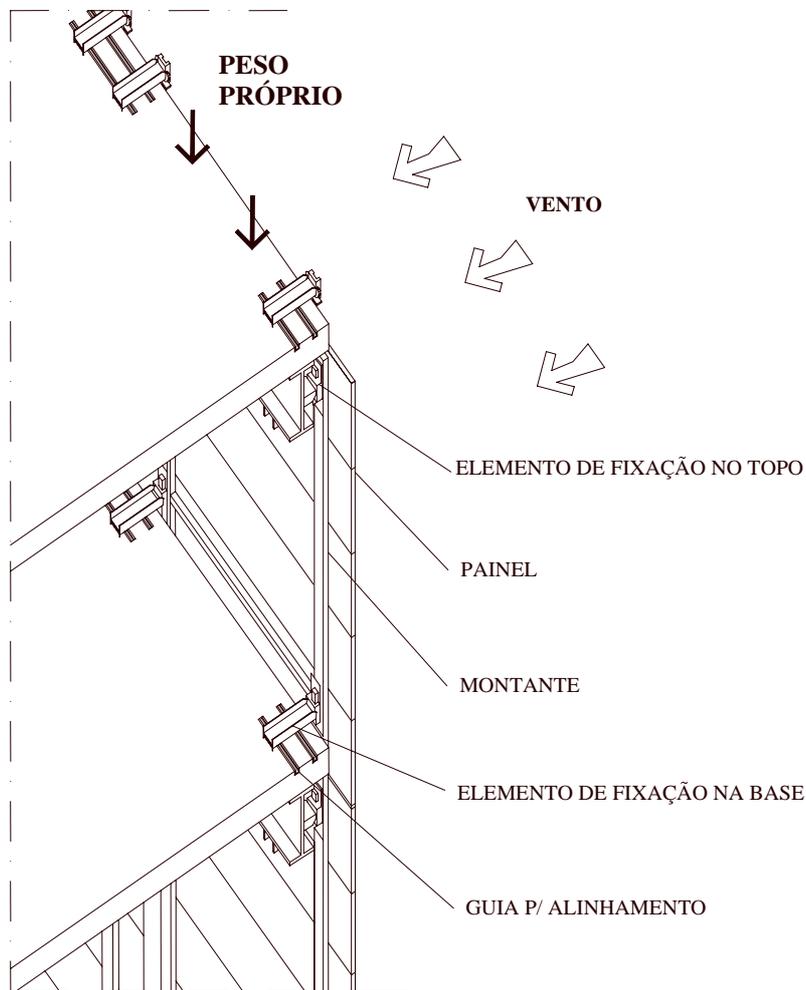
Perspectiva de um painel cortina metálico fixado nas lajes.
